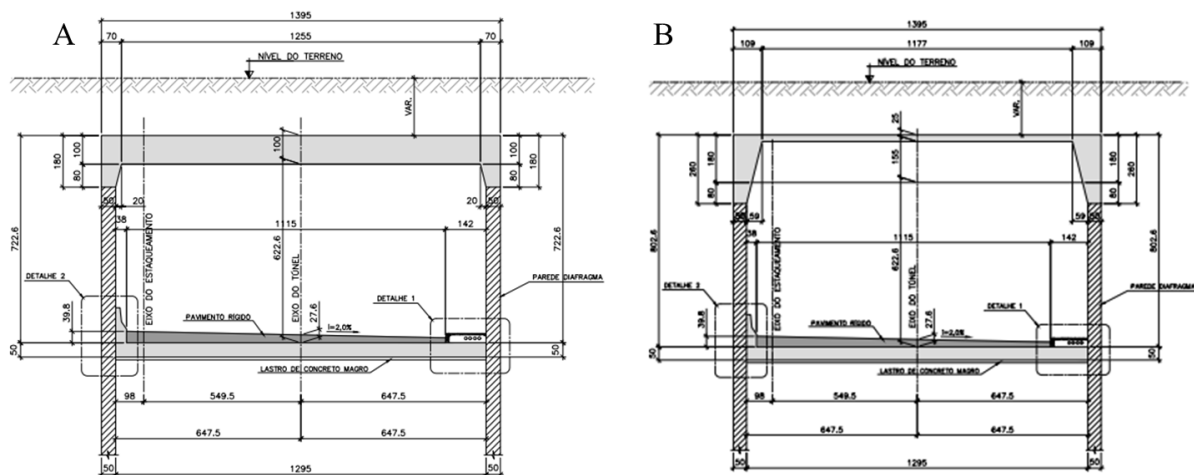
(A) Seção com laje maciça; (B) Seção com laje nervurada.
